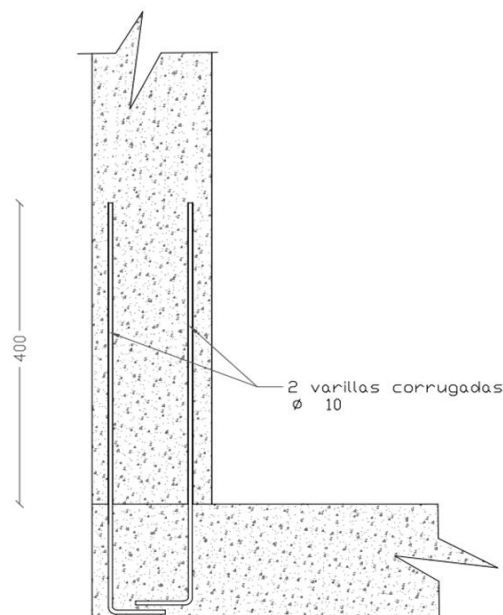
Esquema de la conexión entre las vigas de los extremos y la losa de hormigón.
